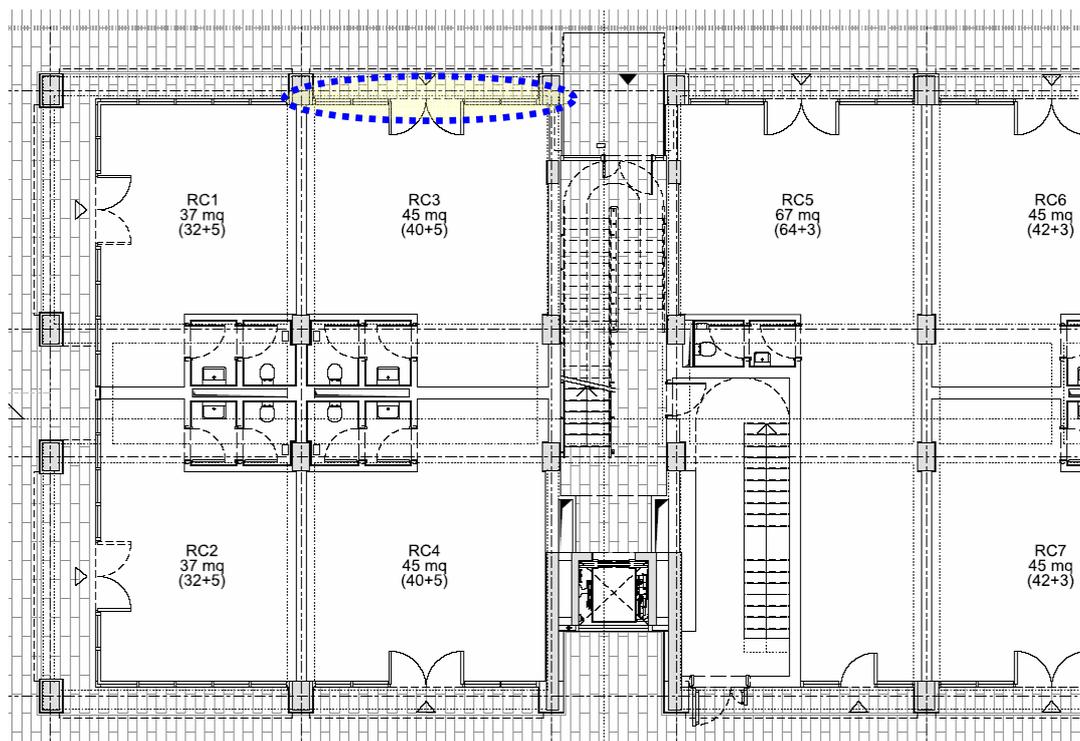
Indicazione in pianta della facciata oggetto di valutazione
